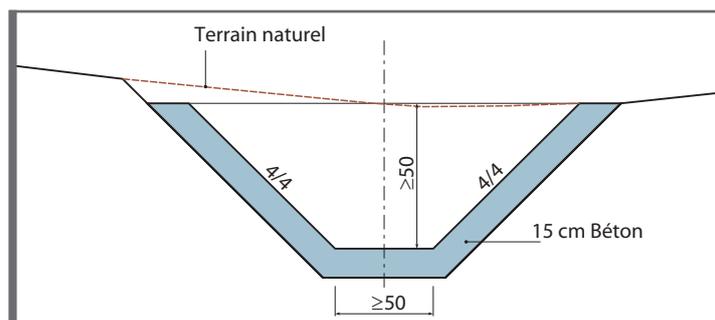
Fossé de section trapézoïdale en béton préfabriqué
